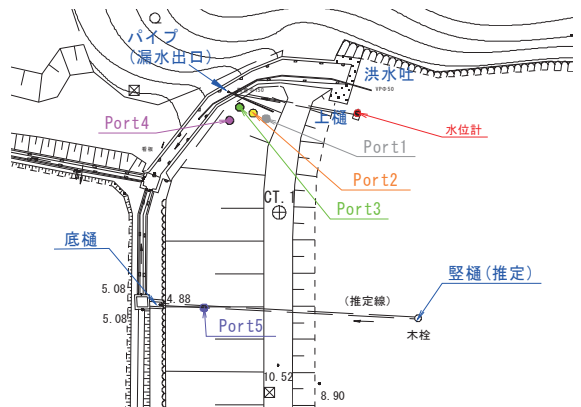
土壌センサー設置平面図 (島根県⁷⁾に加筆)
